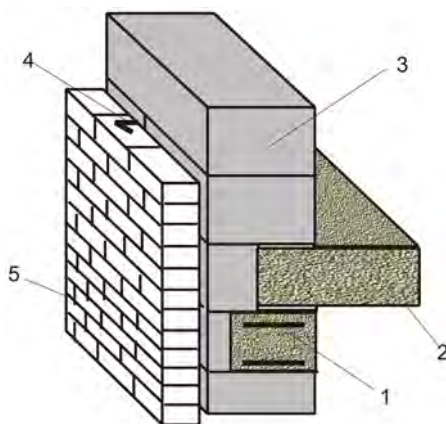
Конструкция внешней стены из газосиликатных блоков: 1 — монолитно-армирующий пояс; 2 — плита перекрытия; 3 — газосиликатный блок, в качестве кладочного раствора применяется монтажный клей; 4 — базальто-волоконные связи, расход составляет 6–7 шт./м²; 5 — кладка из лицевого кирпича
